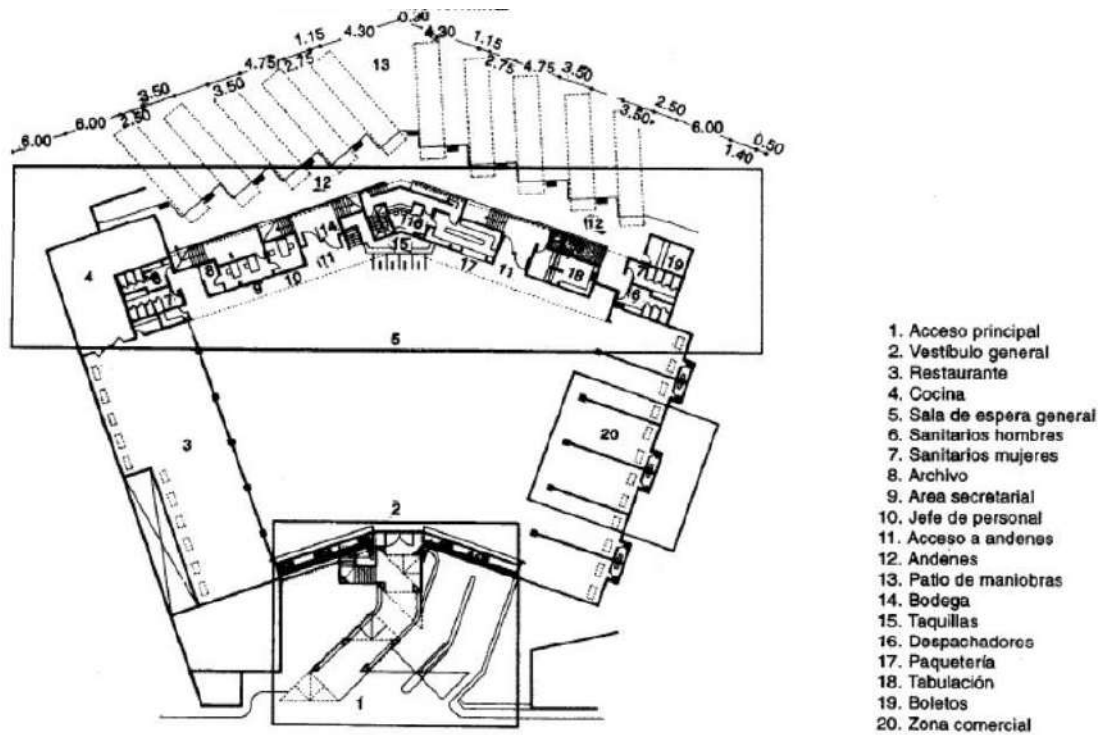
Planta de distribución arquitectónica de transporte federal de pasajeros – México – 1985 (Alfredo Plazola, 2001).
